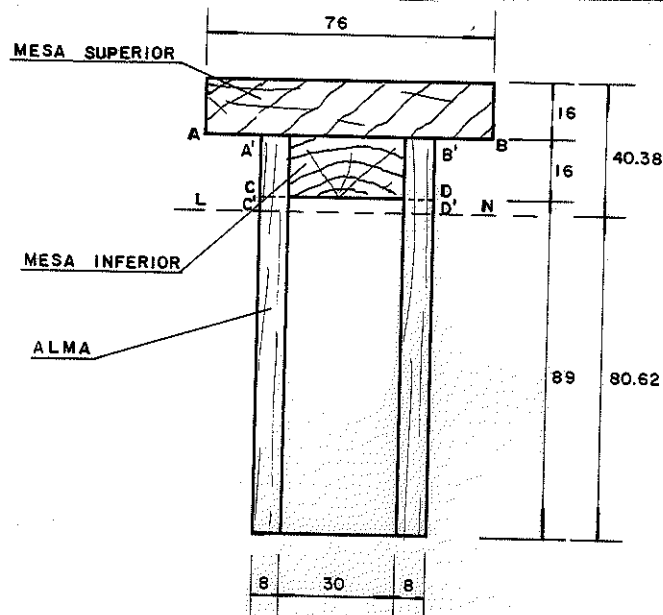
SEÇÃO TRANSVERSAL DA VIGA
